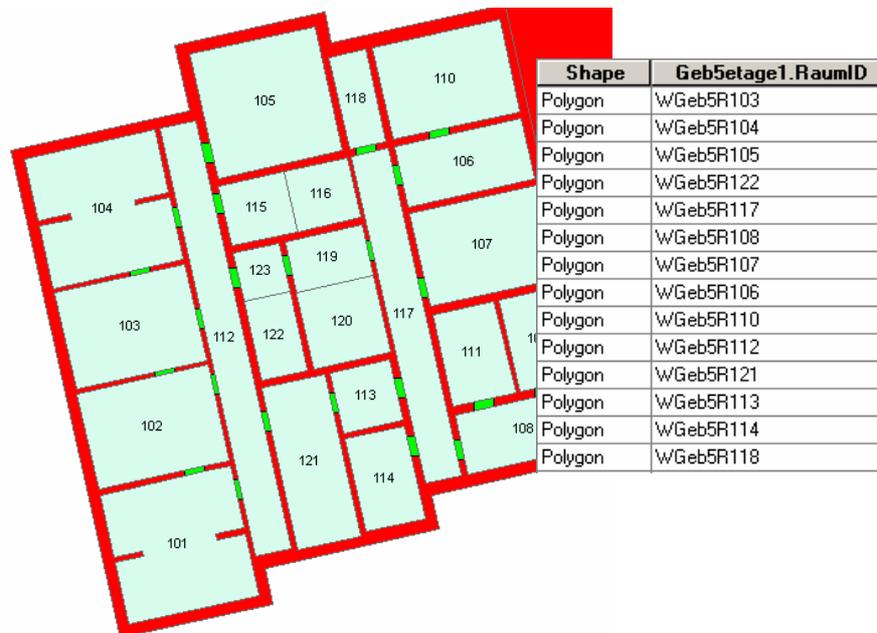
Grundriss Hochhaus Warnemünde 1. Etage
